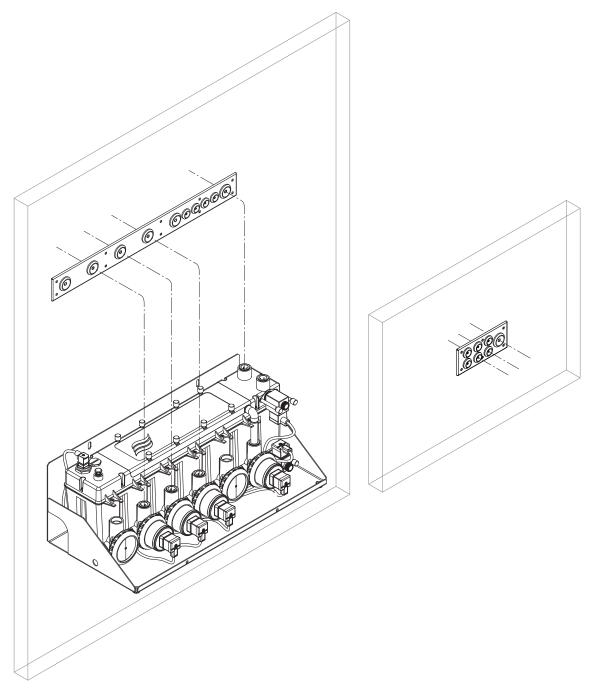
Durchführungsbohrungen markieren (Aussenmontage)
